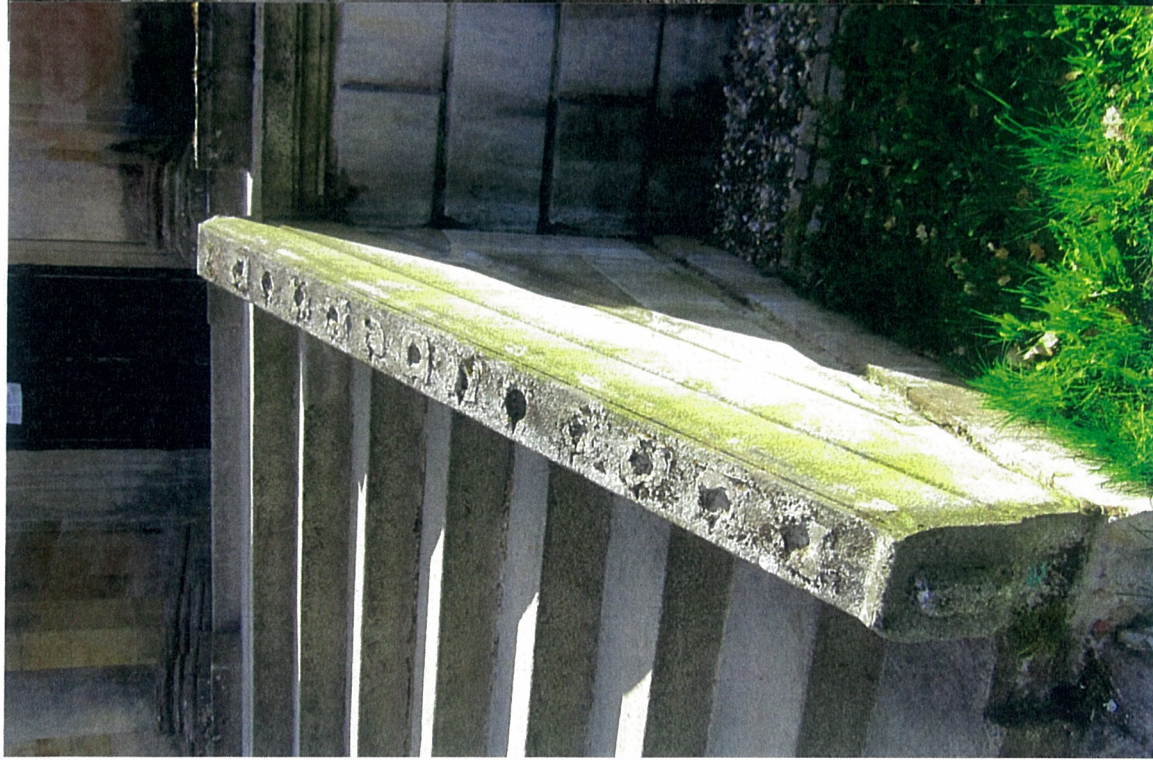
DETAIL POŠKOZENÍ PROFILACE TRNOŽE BALUSTRU, DOLE FOTO
